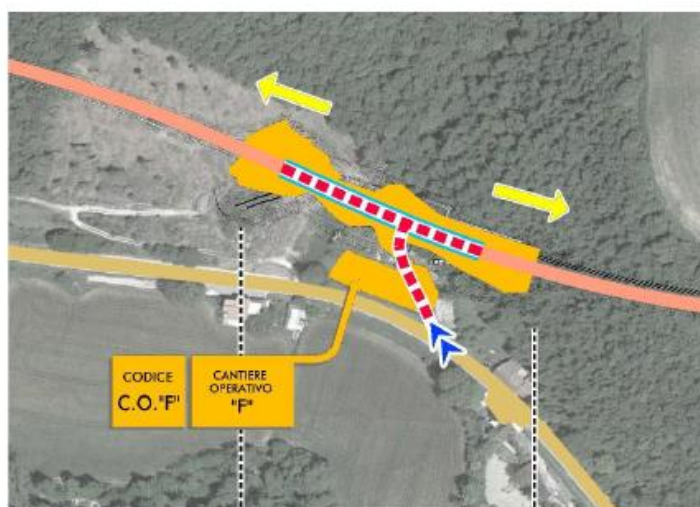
Planimetria con indicazioni della viabilità per il collegamento alla zona degli imbocchi Pietralunga 2 Est e Molinello Ovest (Estratto dall'elaborato T00CA01CANPL01A)
